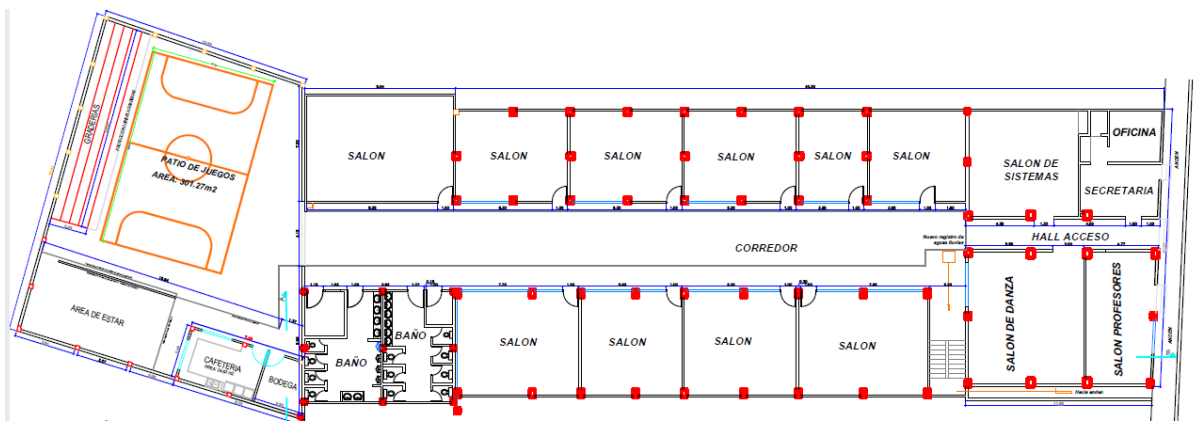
Planta 1er Piso Colegio. Existente. CAJASAI.
